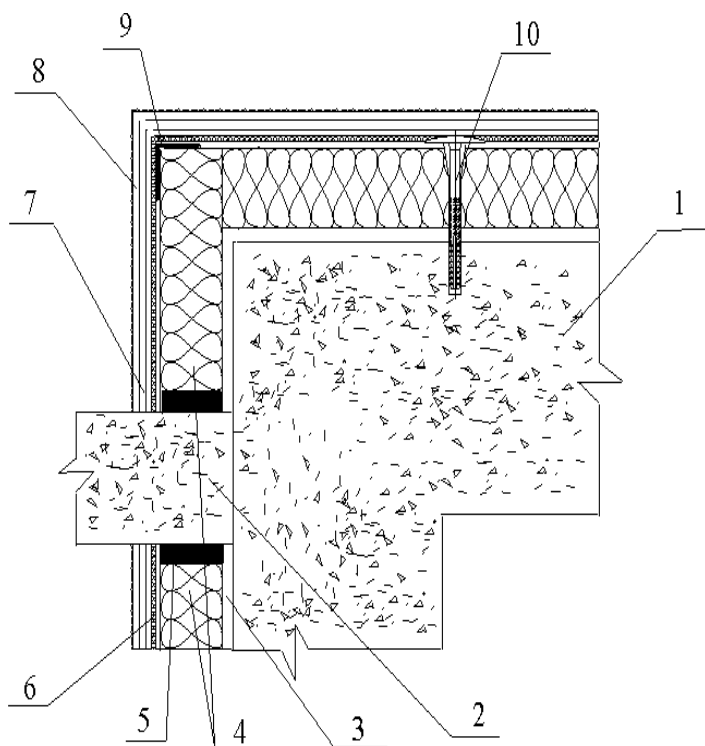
Фрагмент утепления наружной стеновой конструкции у железобетонного ограждения балкона.
